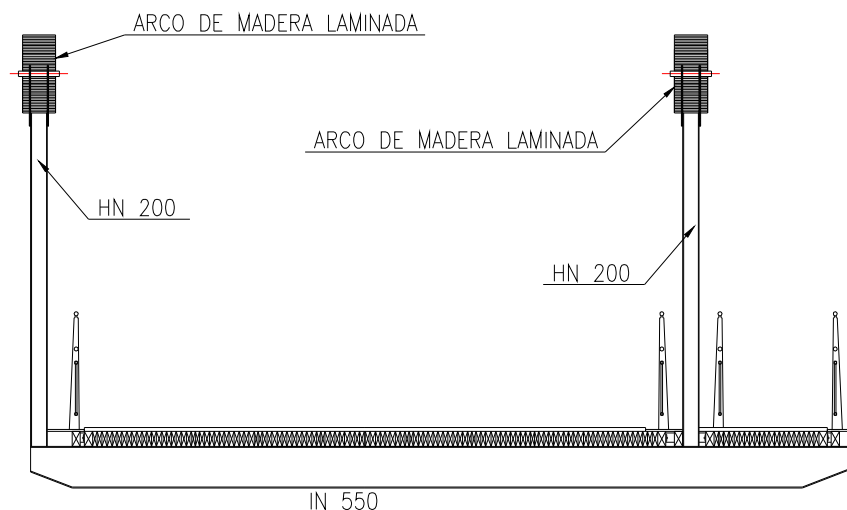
Marco rígido formado por los elementos de cuelgue y las vigas transversales.
